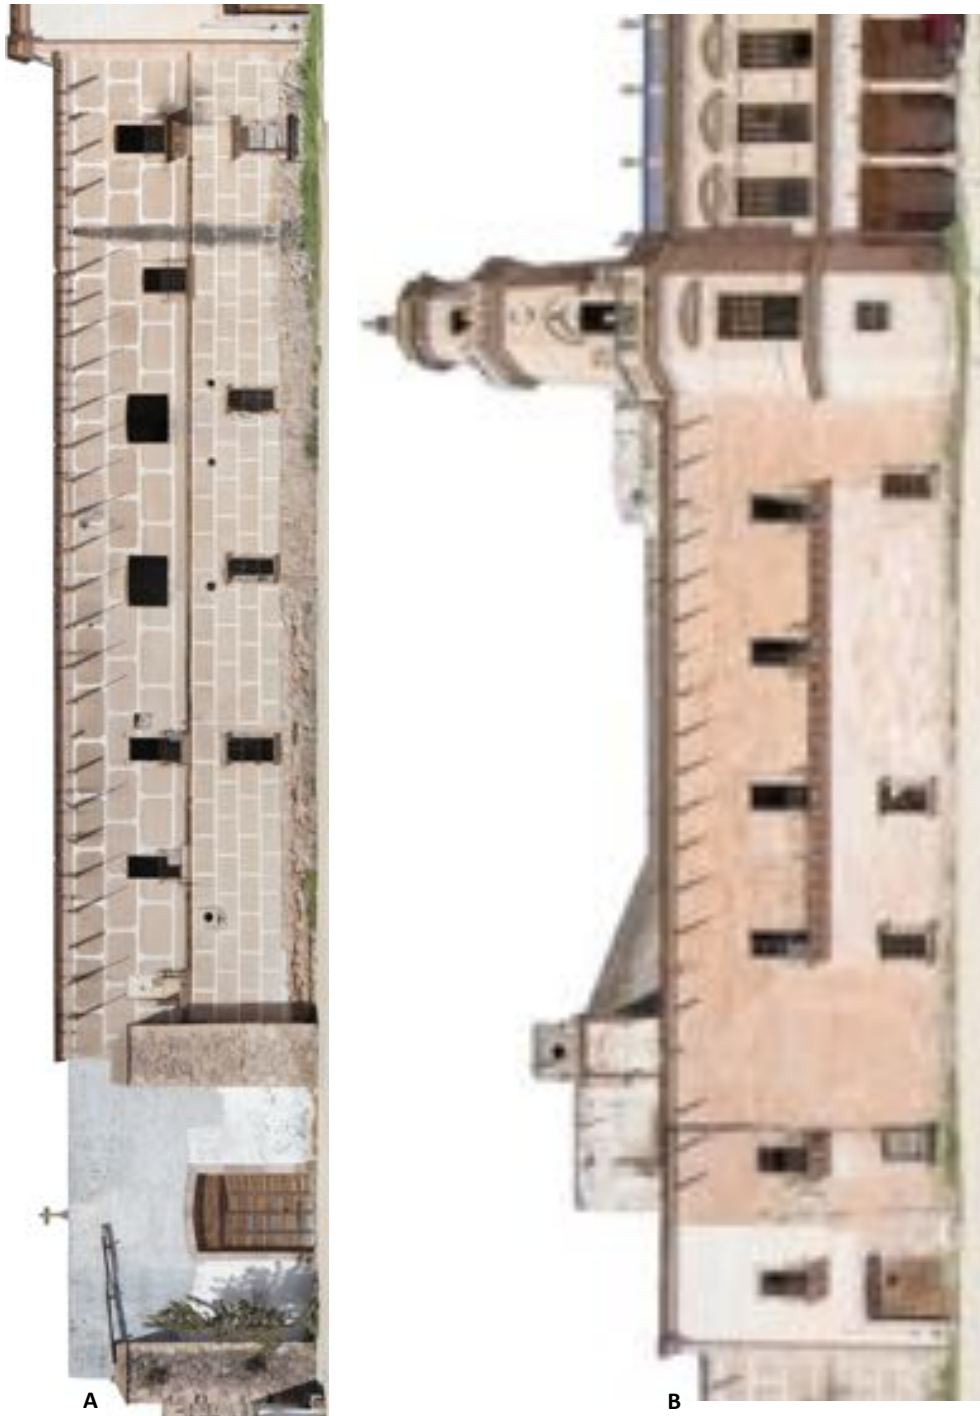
Fachada del conjunto habitacional. División de la imagen en partes A y B.
